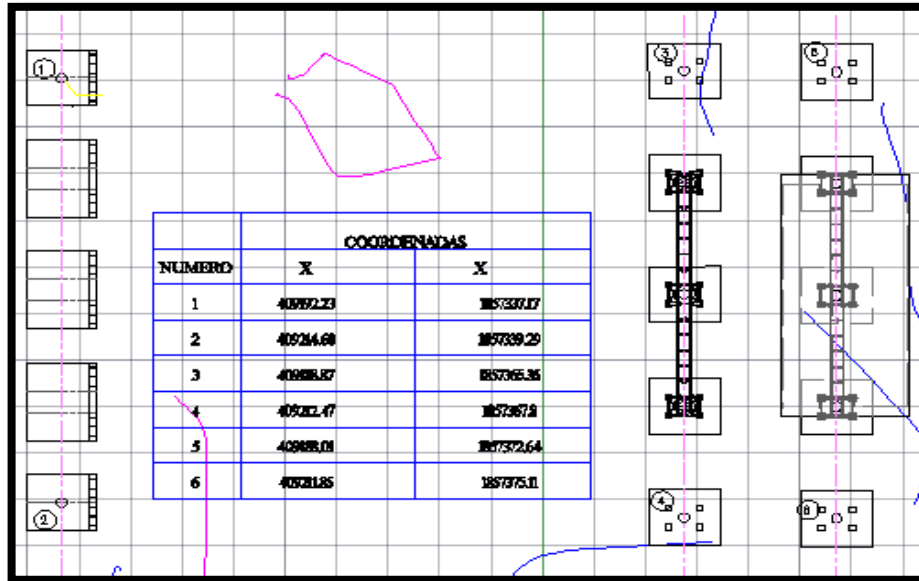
Ubicación de anclas y zapatas de las torres de construcción.
